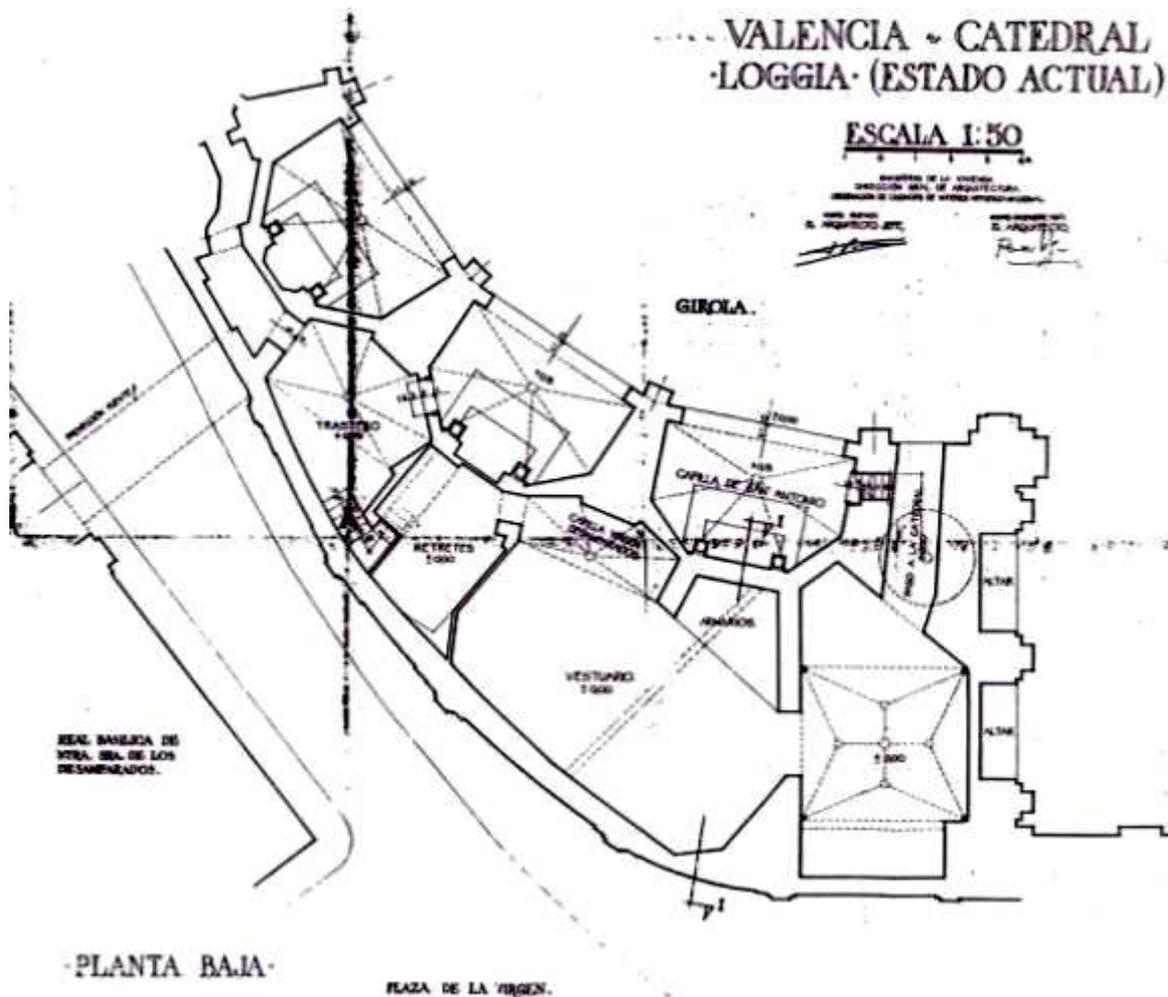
15.9 Planta baja de la Logia de los Canónigos. Estado actual, 1974. 531
